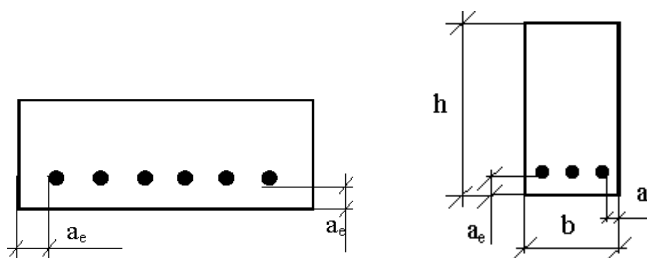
Товщини захисного шару бетону залізобетонних конструкцій
